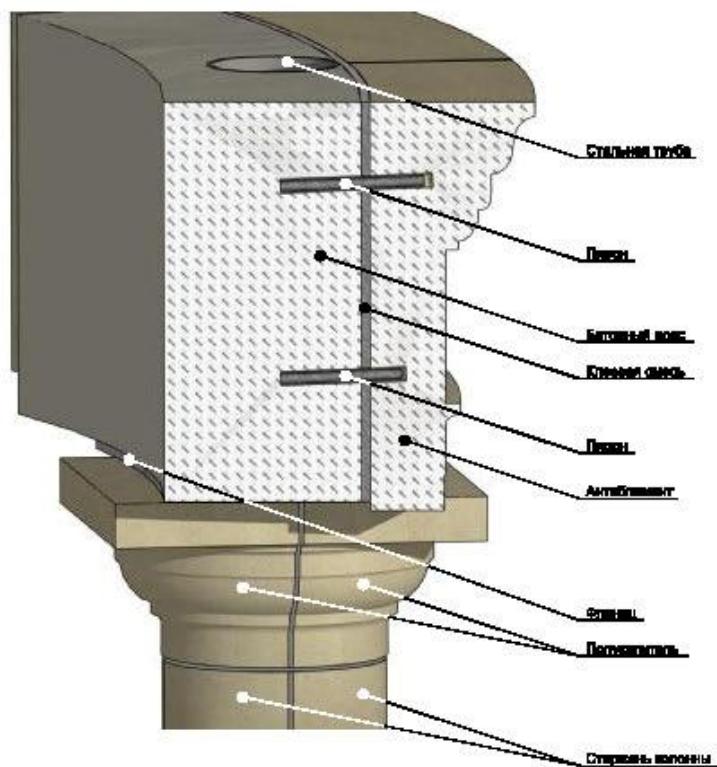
Схема монтажа антаблемента на бетонный пояс.
